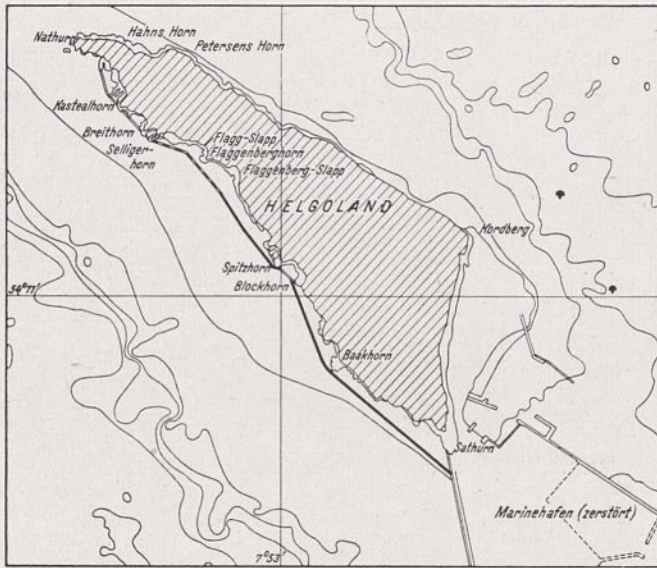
Lageplan der Fortifikationsmauern und des Abschlusses der Südwestschutzmauer.
